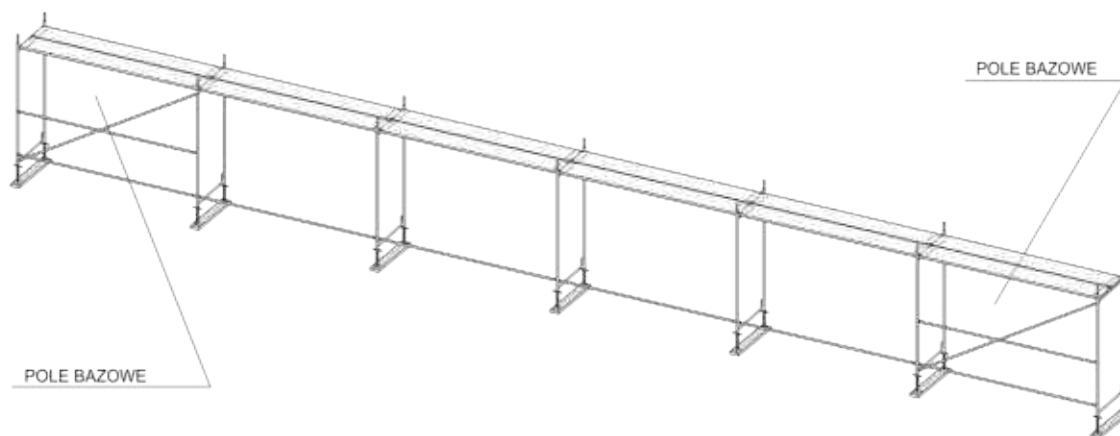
Zmontowane pole bazowe pierwszej kondygnacji
